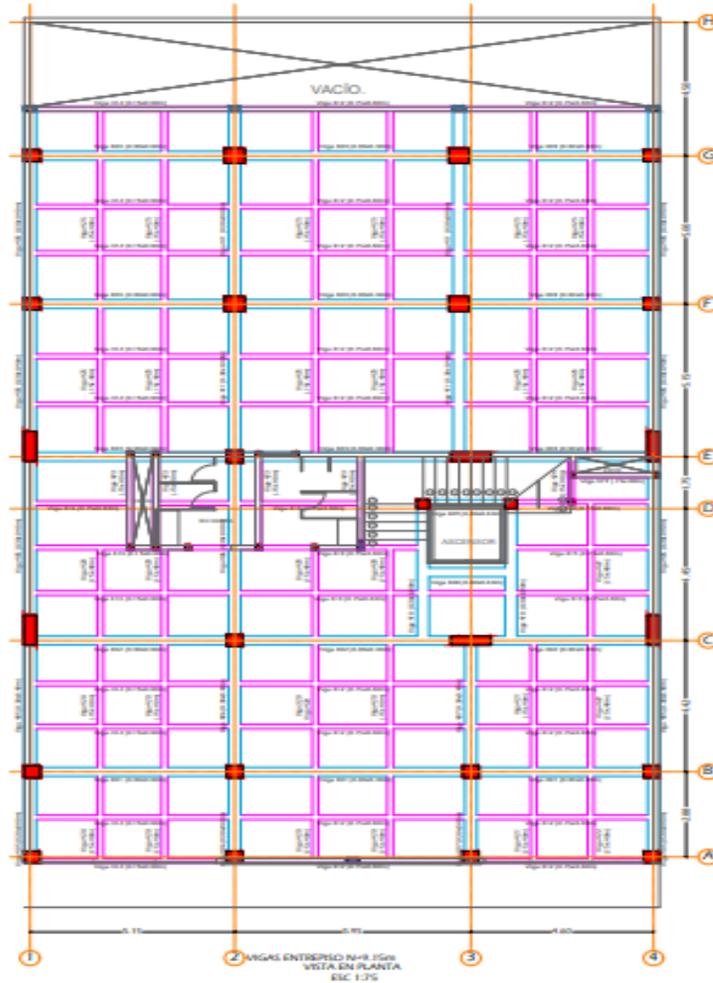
Vigas entrepiso vista en planta del plano estructural Wiedii
